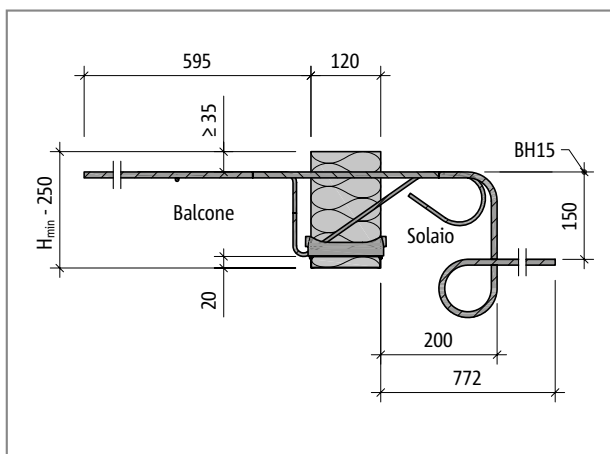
Schöck Isokorb® tipo KXT30-BH15: sezione dell'elemento
